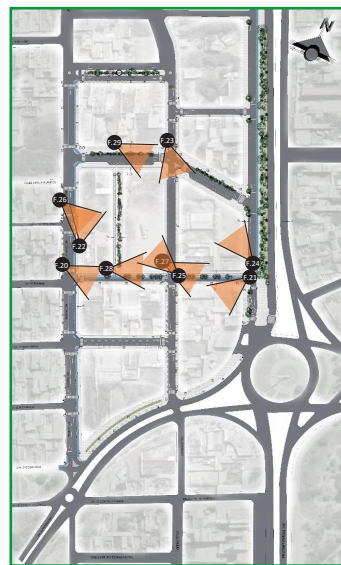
Planimetría General. Plano de Propuesta del Barrio “Los Mecánicos” con ubicaciones de los fotomontajes.
